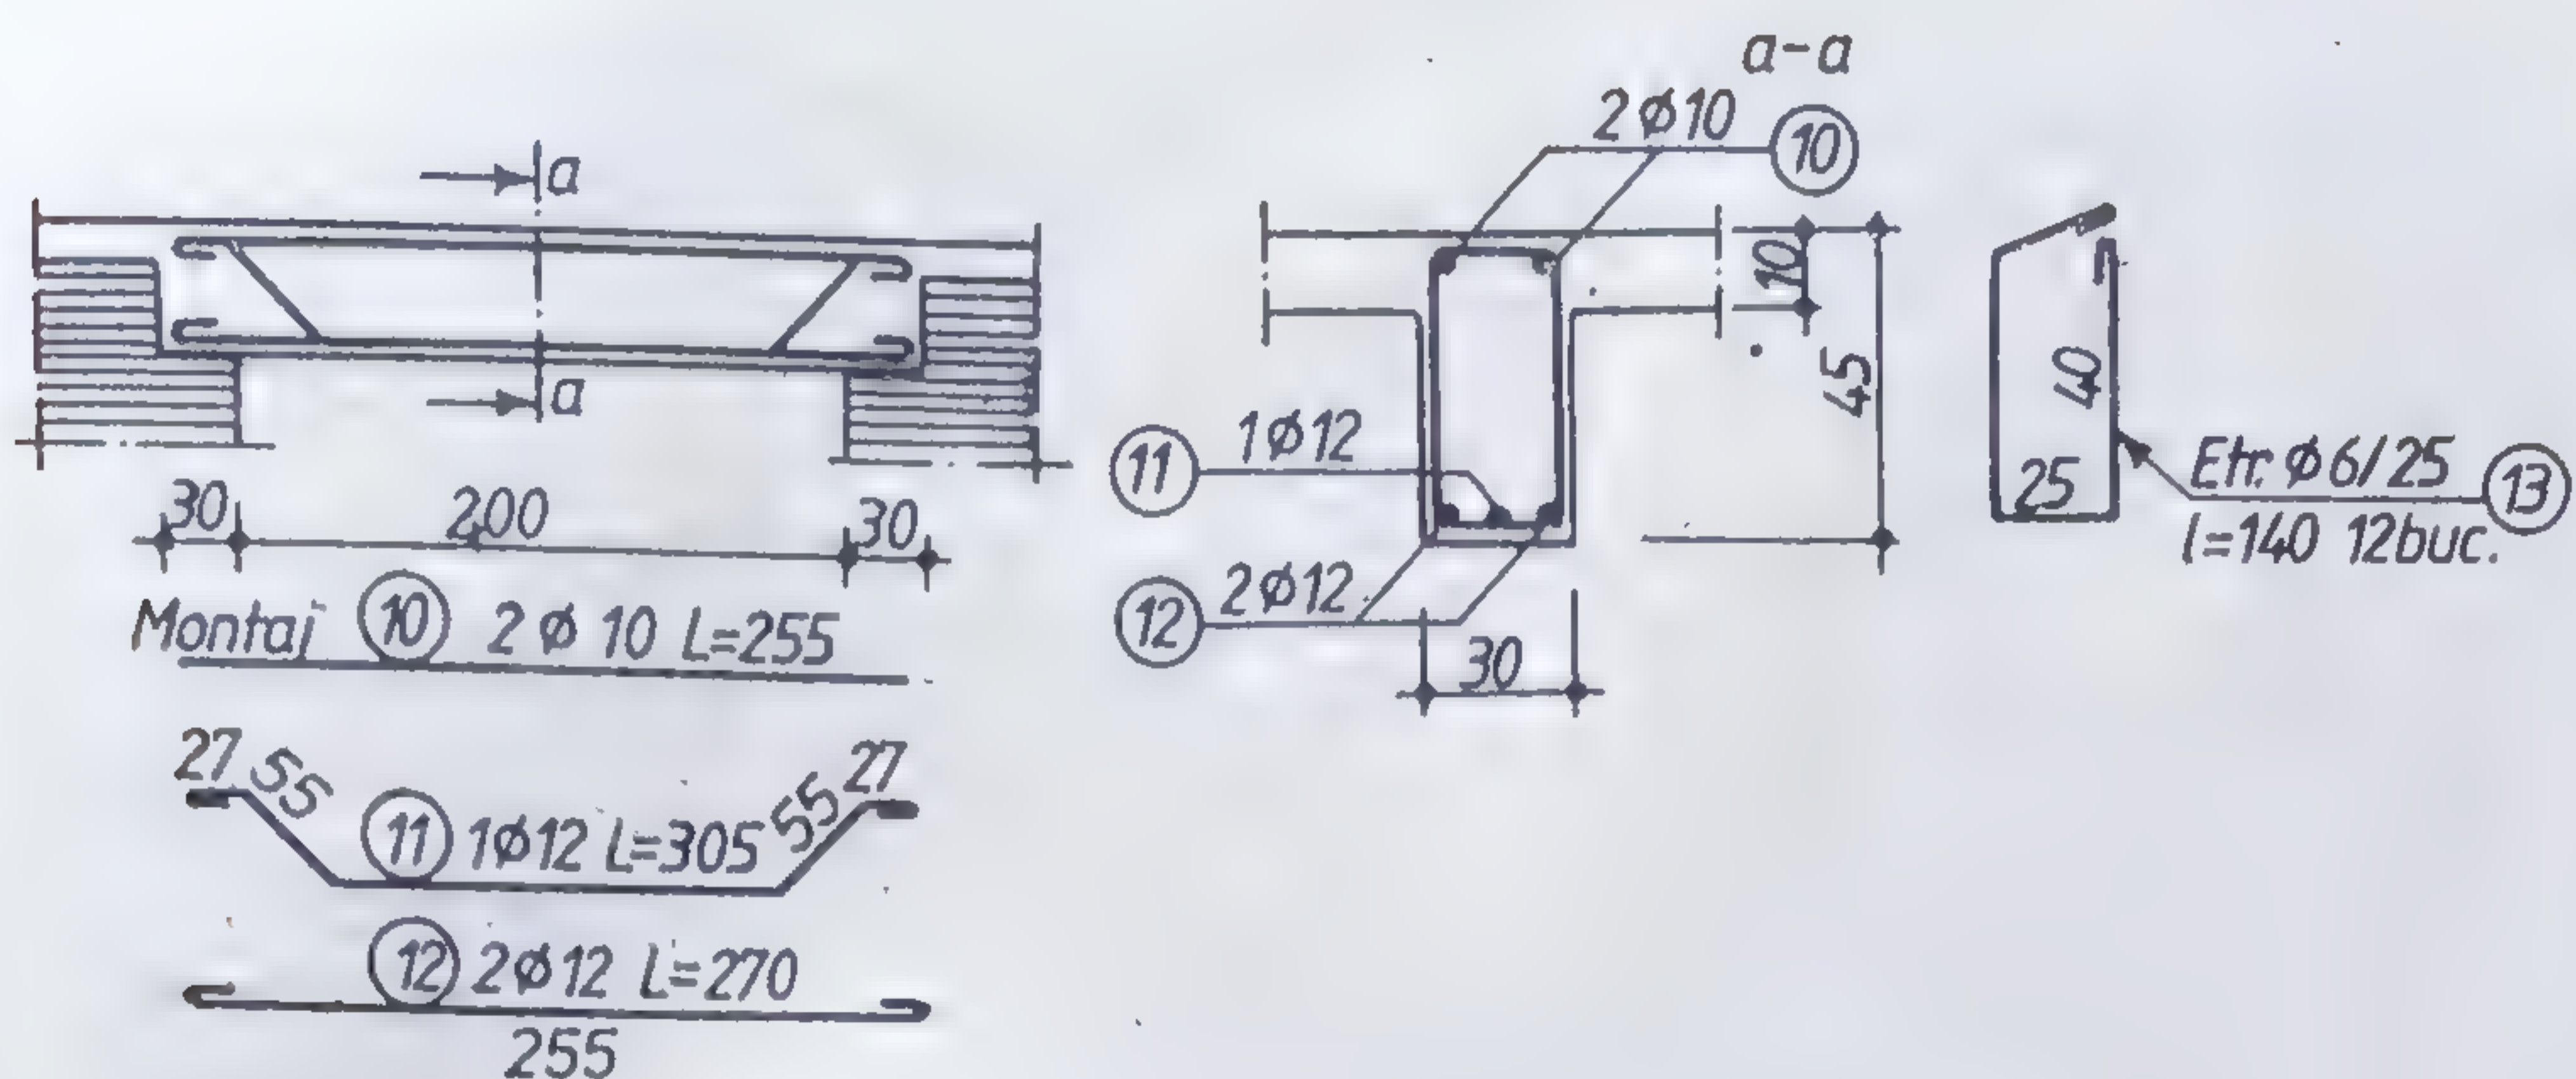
Detalii de armare a unei grinzi de beton armat.
